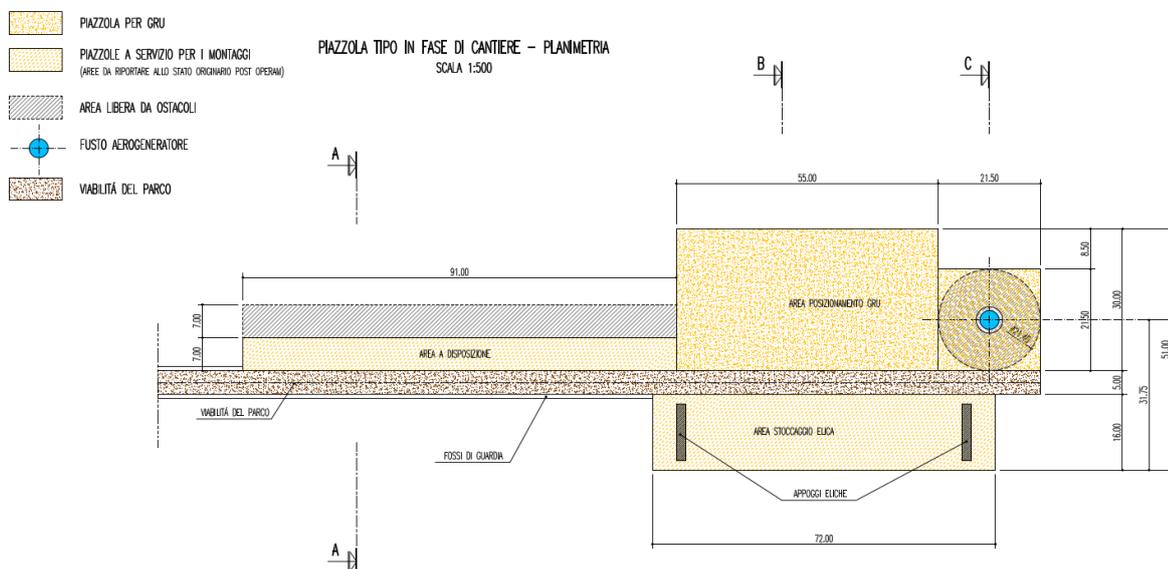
Piazzola tipo in fase di cantiere
